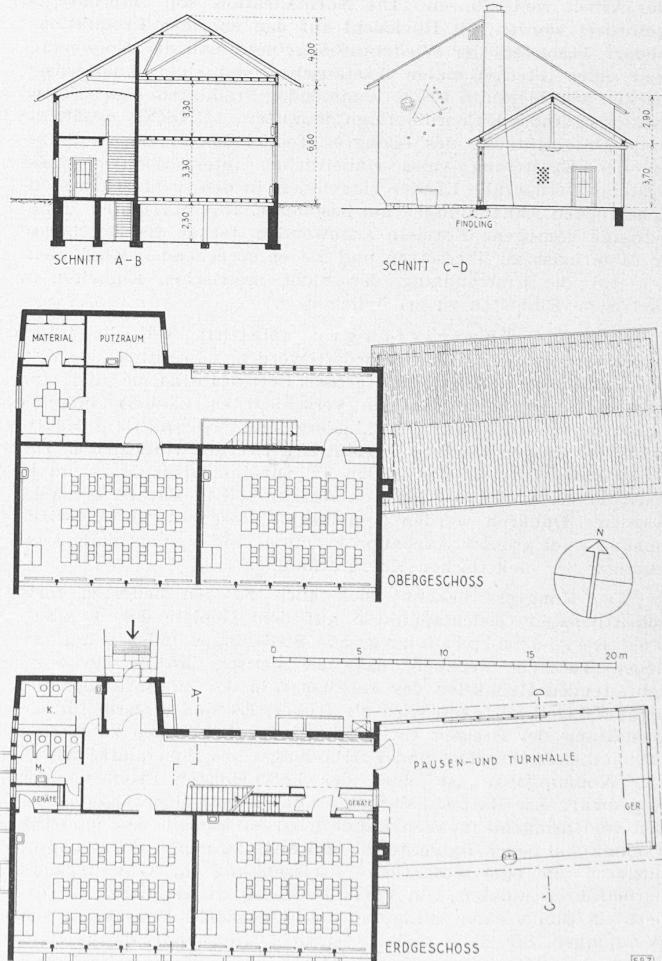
Schulhäuschen auf der Egg. Schnitte und Grundrisse 1:400
